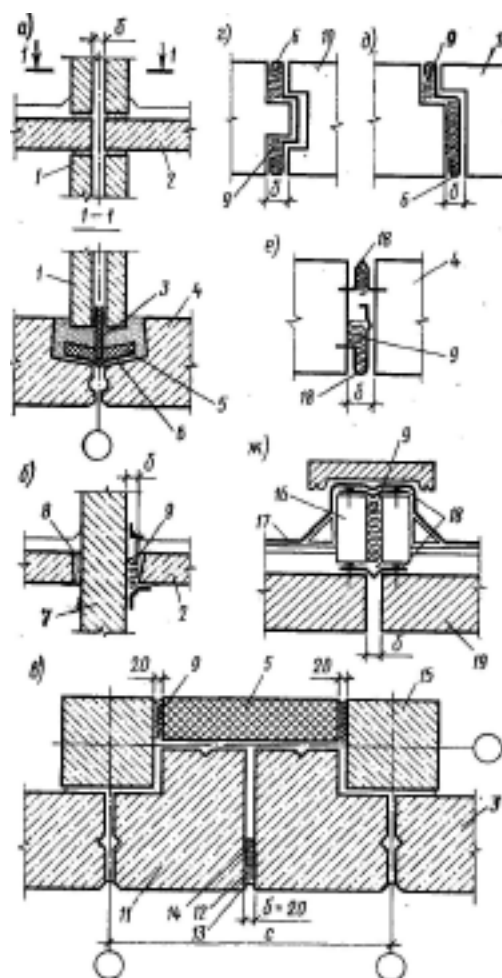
Конструктивные решения деформационных швов во внутренних, в наружных стенах и в покрытиях:
